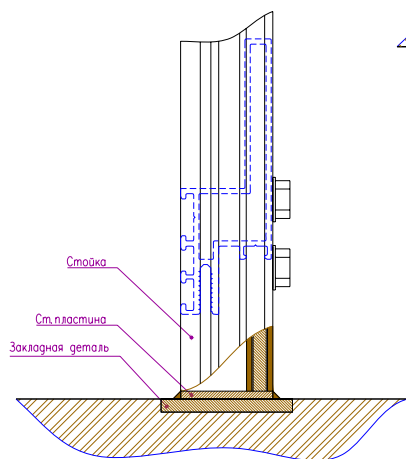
Нижний монтажный узел стойки ТП-50361
